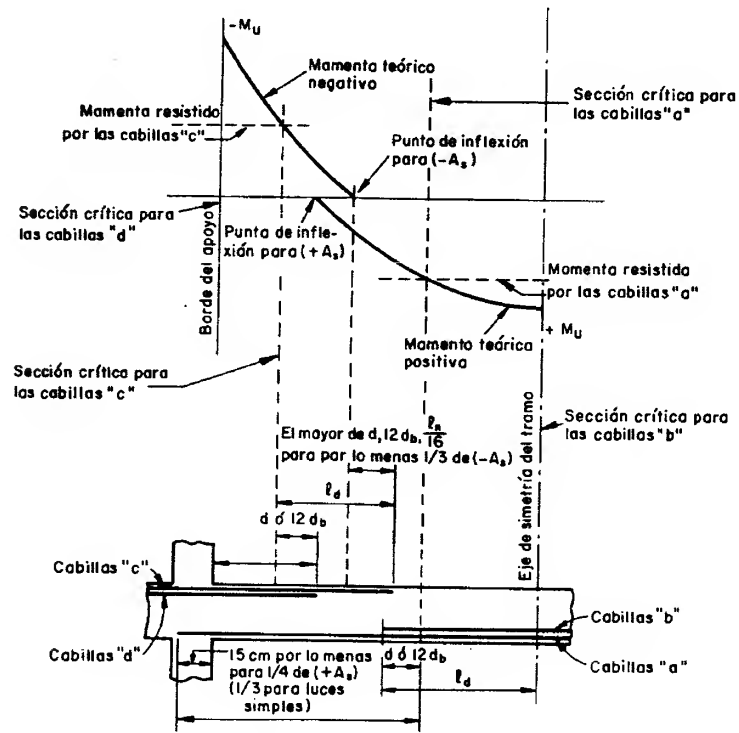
Desarrolla de las armaduras a flexión en una viga continua típica
